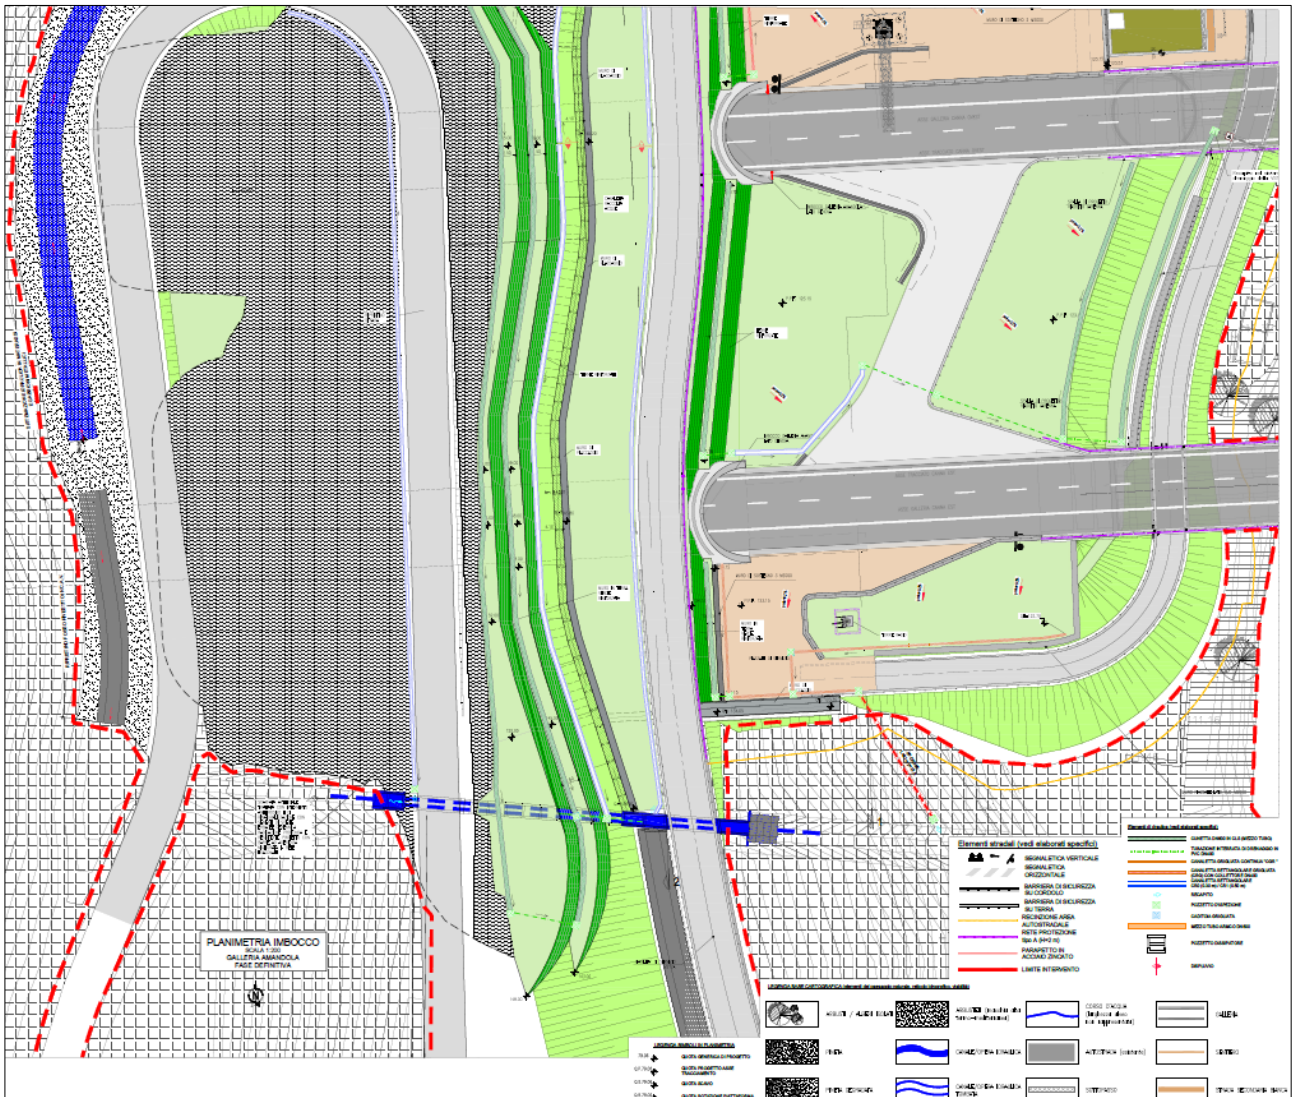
Planimetria stato finale area di imbocco 2/2 (fonte: elaborato 110728-LL8C-PE-A1-G06-GF06E-SSF00-D-AUA1996-1)
